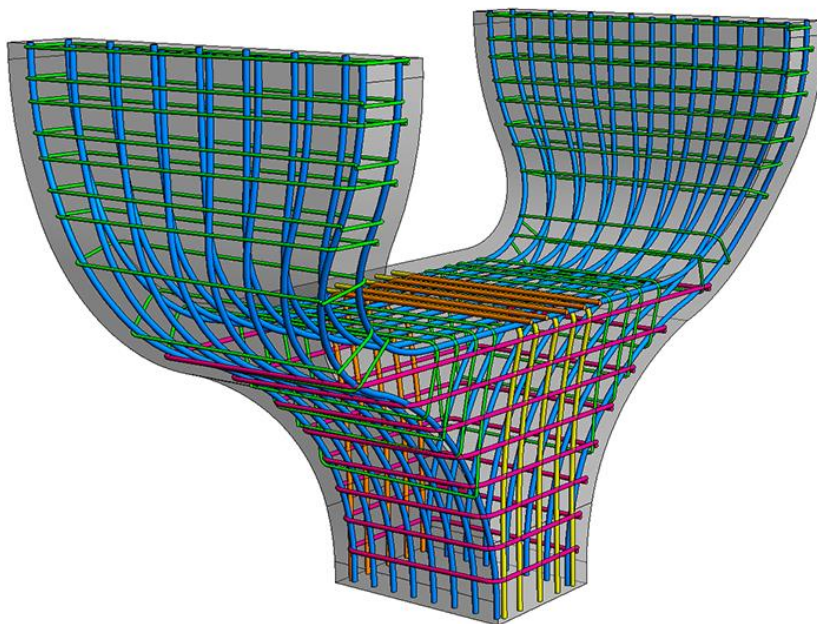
Exemplo da modelação de armaduras em ambiente BIM [24]
